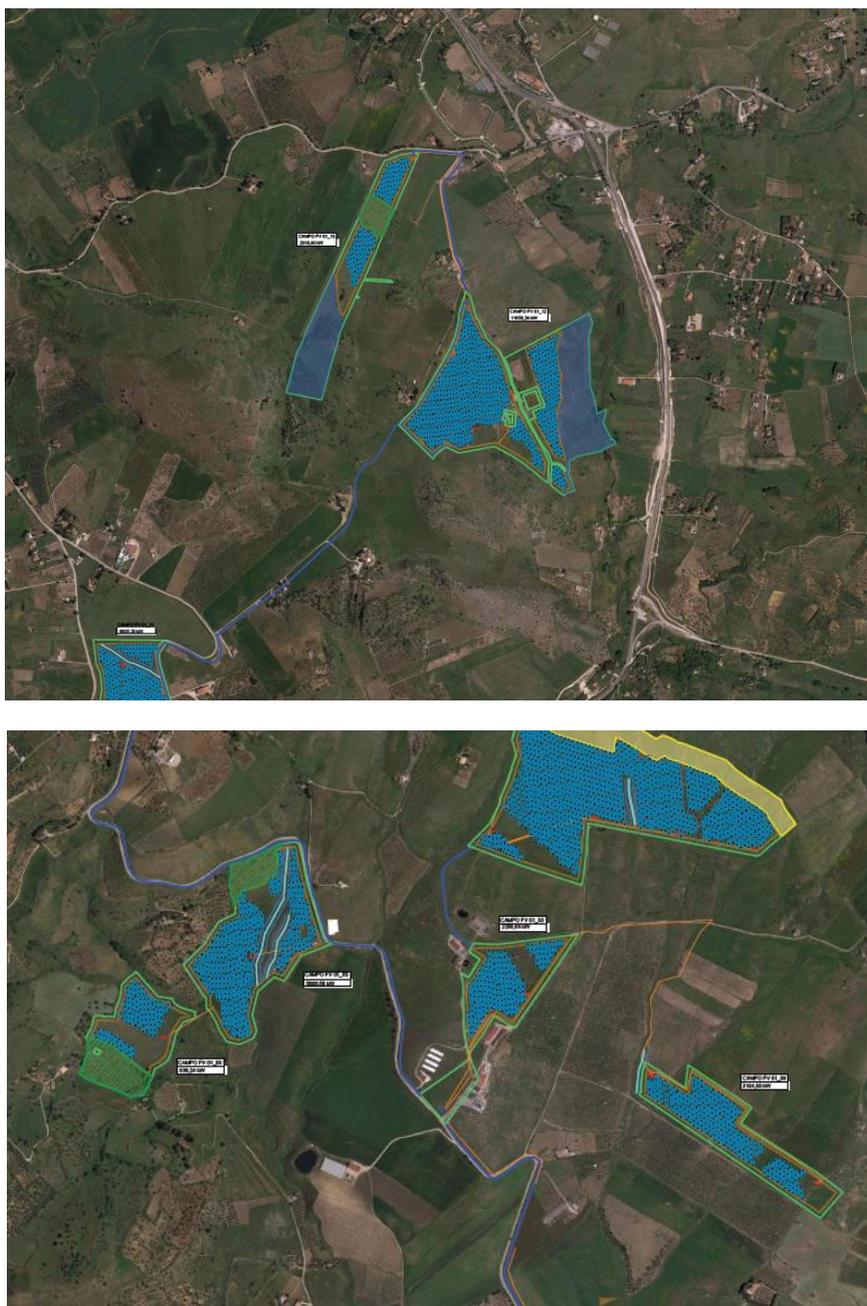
Stralcio Progetto Planimetria impianto su Satellitare (SP01AAEG087)
